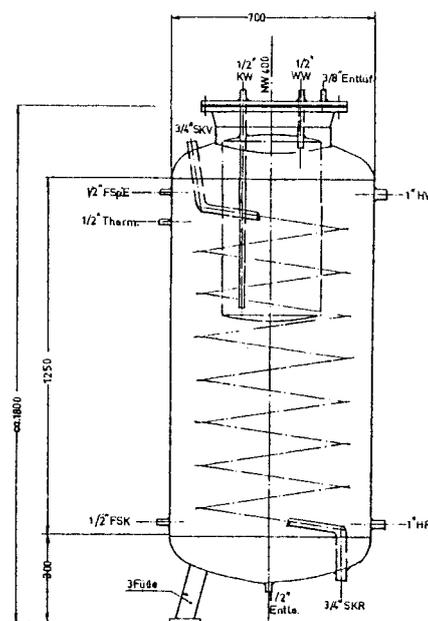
Solarspeicher mit eingebautem Brauchwasserbereiter
